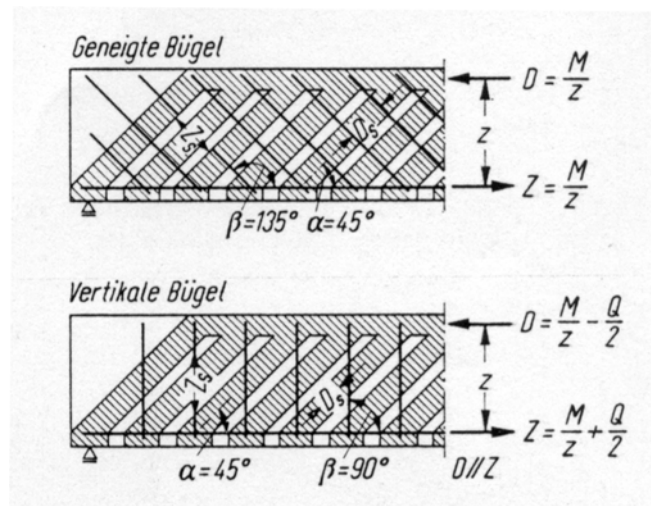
Klassisches Fachwerkmodell nach Mörsch zur Betrachtung querkraftbewehrter Stahlbetonbalken im Zustand II [leon_3]
